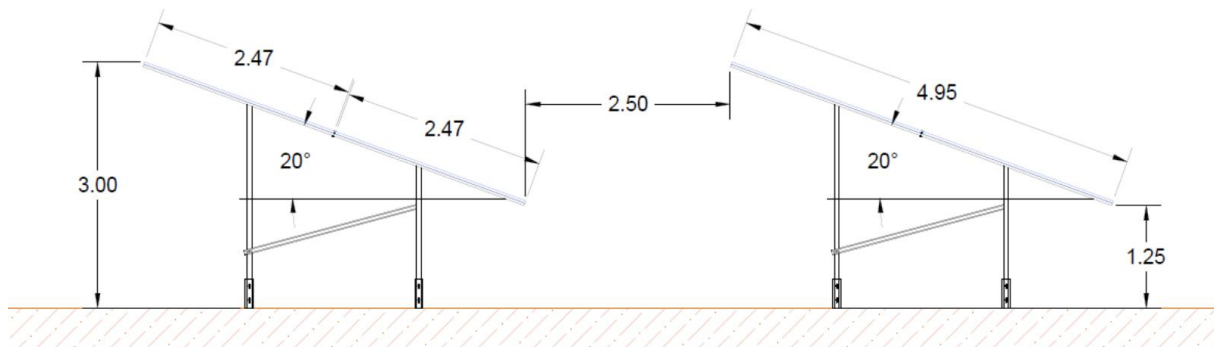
Coupe des structures porteuses prévues sur la partie plane du site d'Armous-et-Cau (Source : CORFU Solaire)
